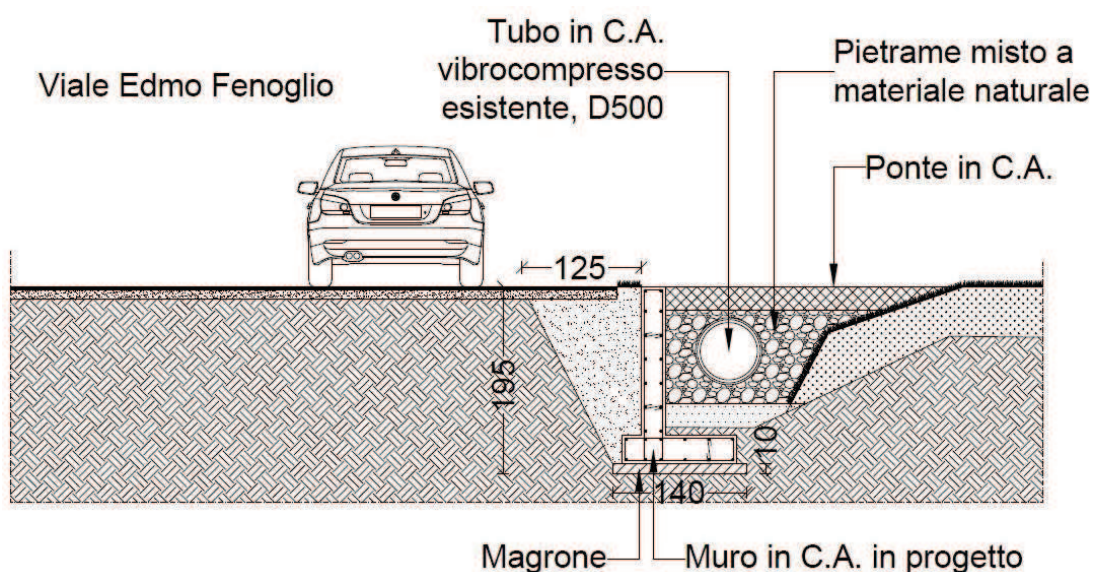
INTERVENTO 2 - Sezione trasversale alla strada
